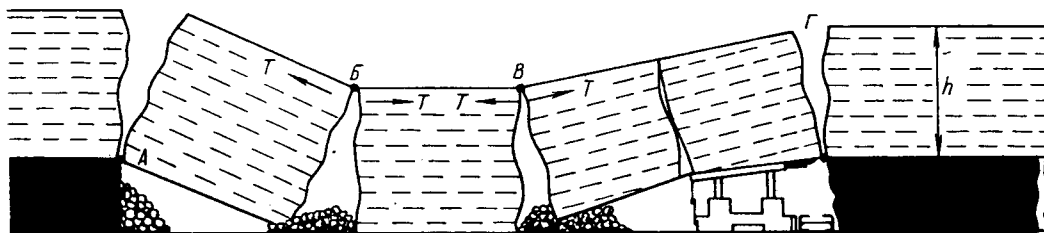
«Шарнирное» размещение обрушенных блоков пород кровли.
